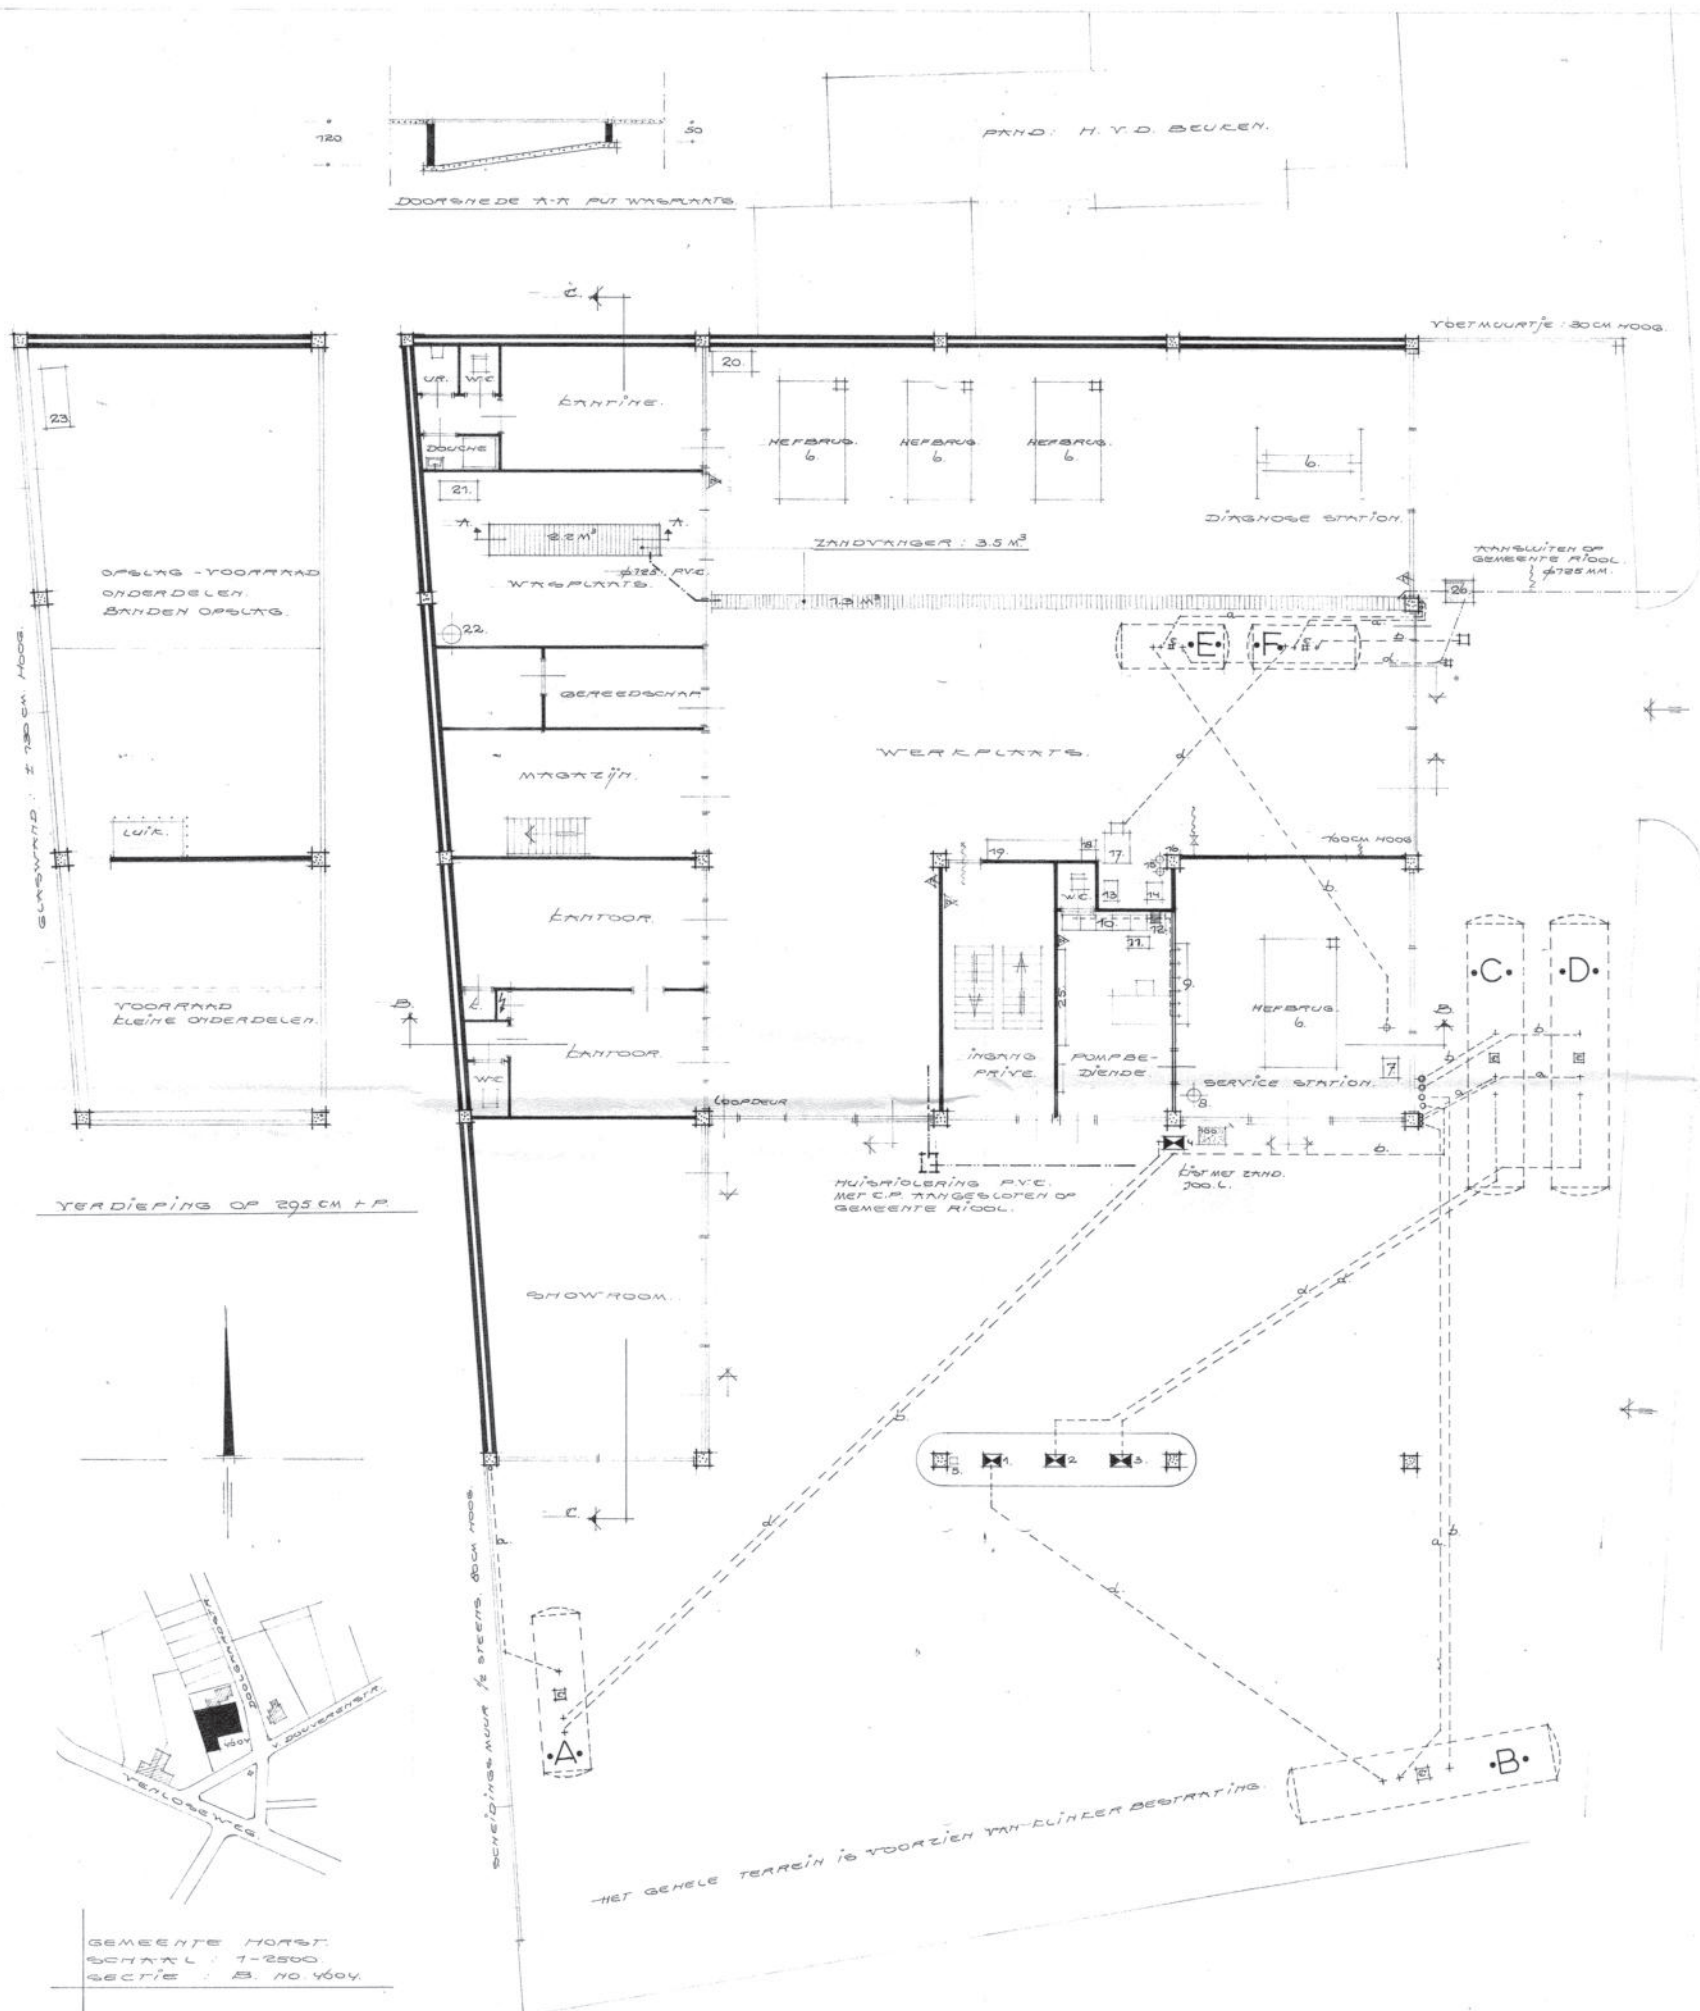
/141/BD, Van Douverenstraat 5 te Horst
